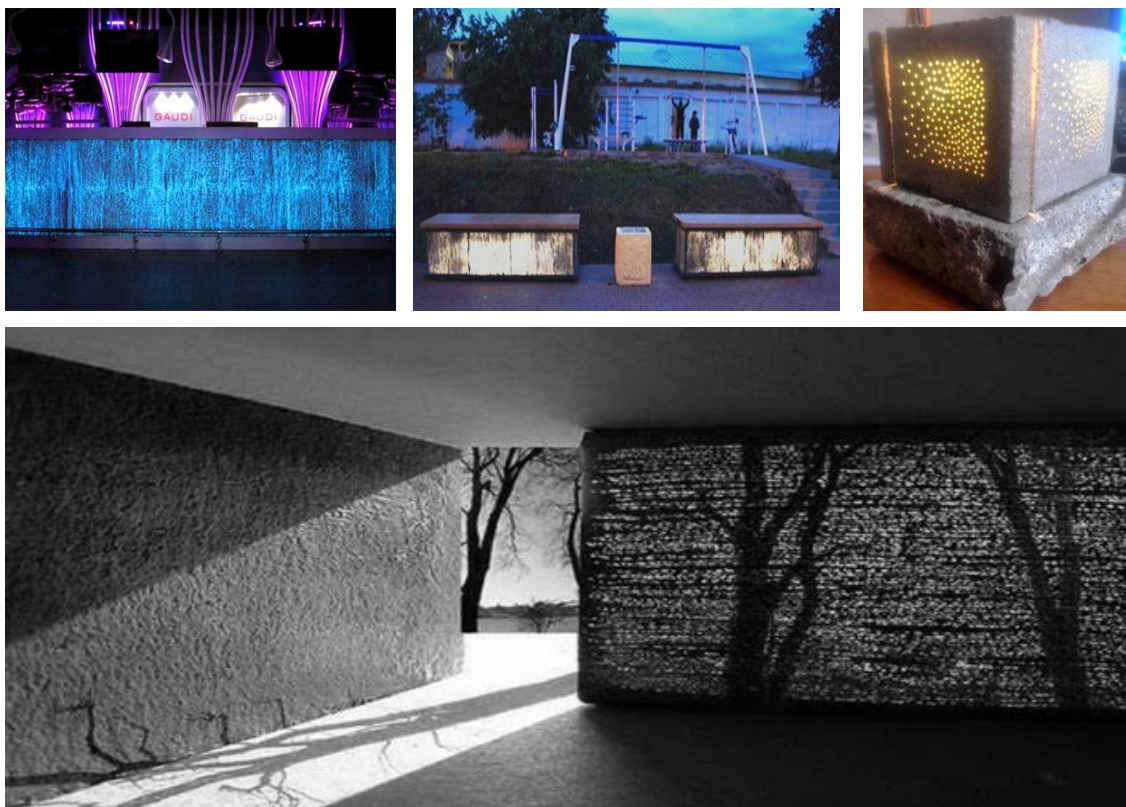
Примеры применения светопроводящих бетонов (стойка бара, скамейка, светильник, стеновая конструкция)
